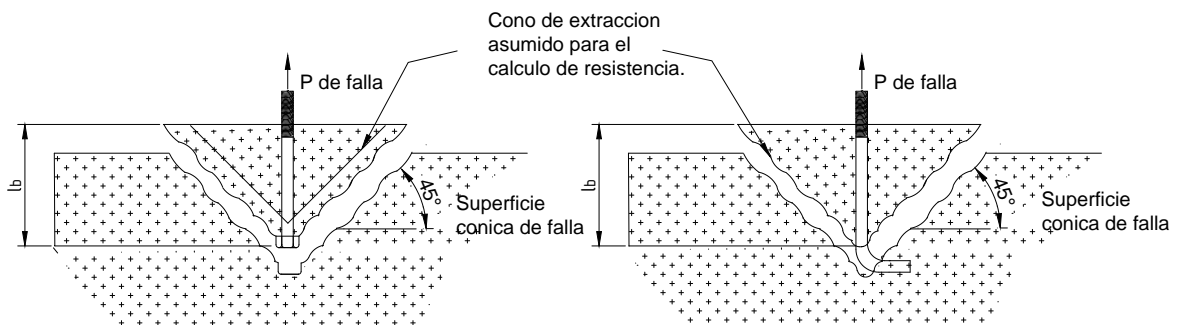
Falla cónica, desprendimiento de la mampostería
